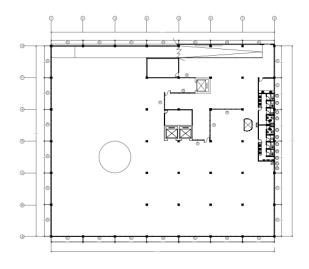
Denah Rencana jendela Lantai 1 Sumber: dokumen pribadi
